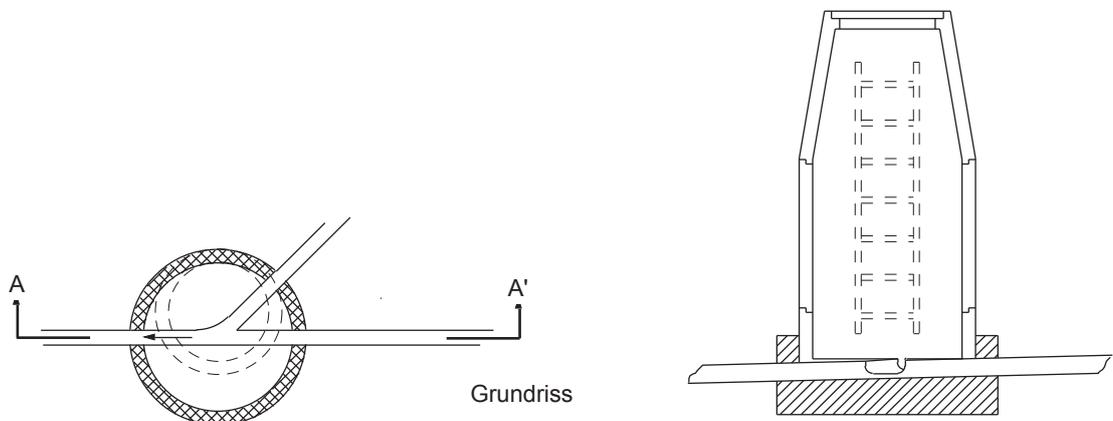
+9 Einstiegsschacht in Grundriss und Schnitt
